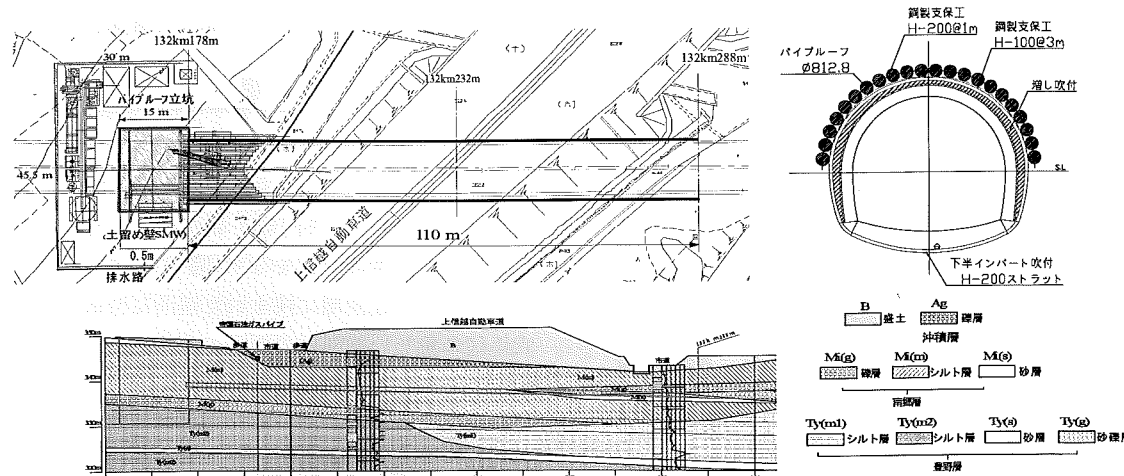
高速道路交差点 位置平面図・地質縦断面・横断面
